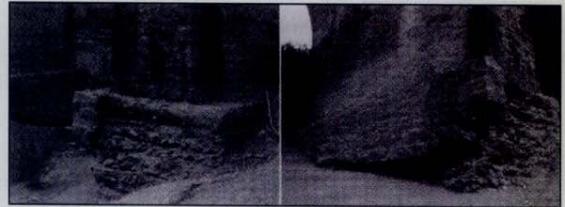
Deterioro de la cimentación de un puente sobre el embalse, detectado a finales del verano, con el embalse en cotas bajas
